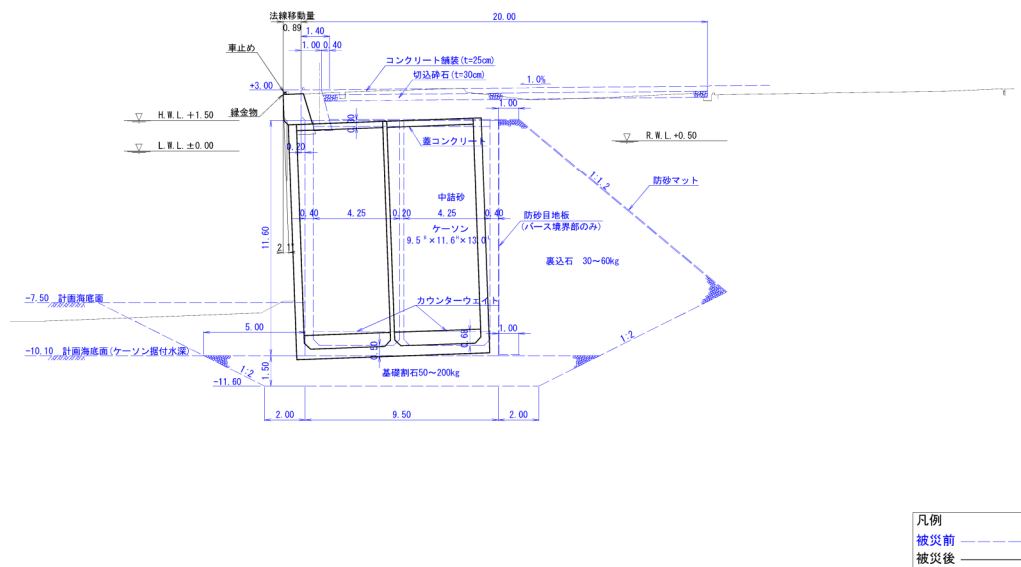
No.13 日立港区\_第5ふ頭地区 5-A 岸壁 (-7.5m) の断面図 (被災前・後)
